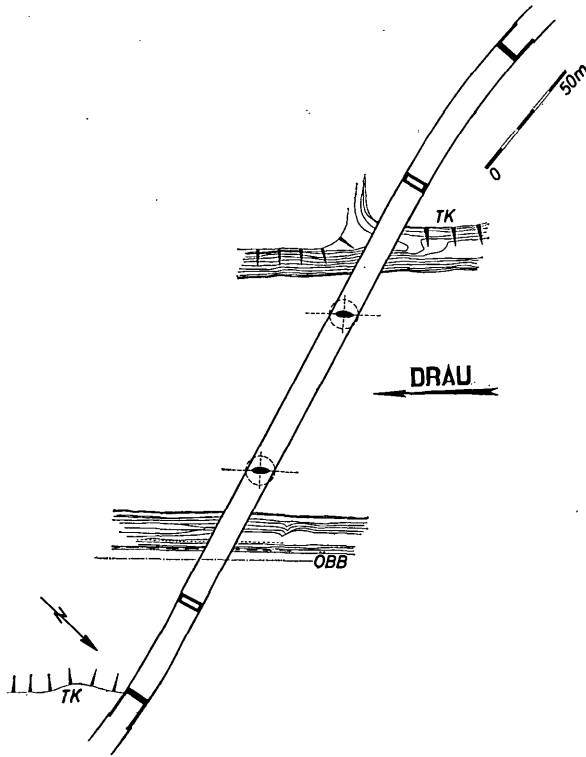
Lageplan der neuen Draubrücke „Villach-Nordumfahrung“ mit den zwei Flußpfeilern.
